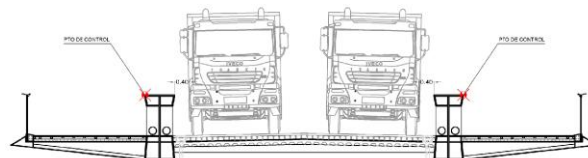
Sección del tablero con planteamiento de la prueba de carga estática.
